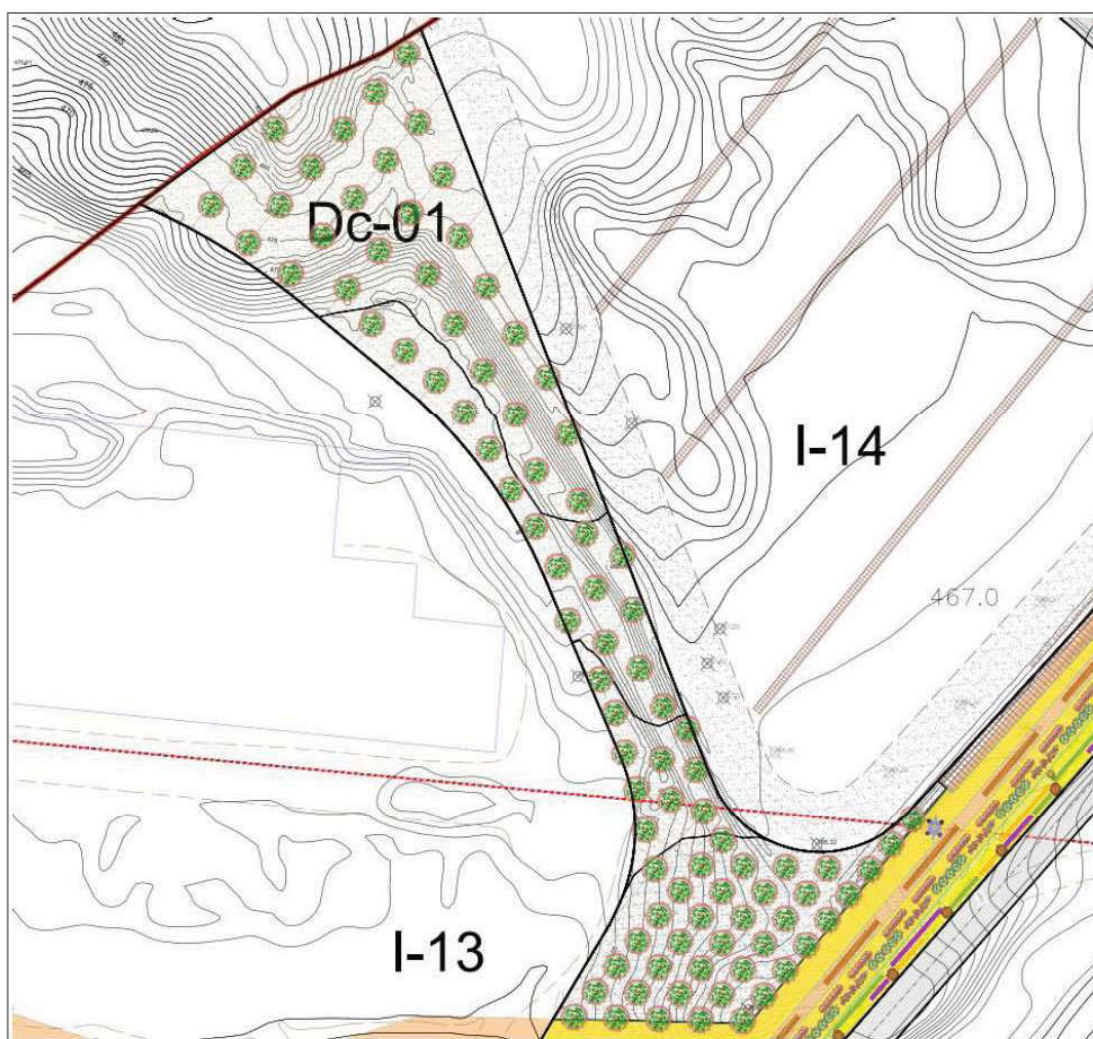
Proyecto en el ámbito de la DC-01 REFORESTACIÓN.
